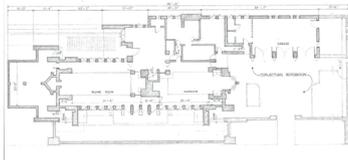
Planta Primera Robie House de Frank Lloyd Wright en 1910.
